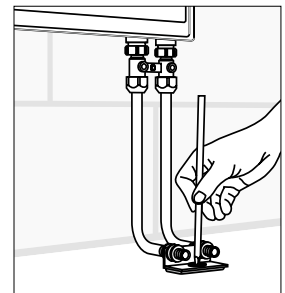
Applicazione del segno corrispondente al punto di fissaggio
